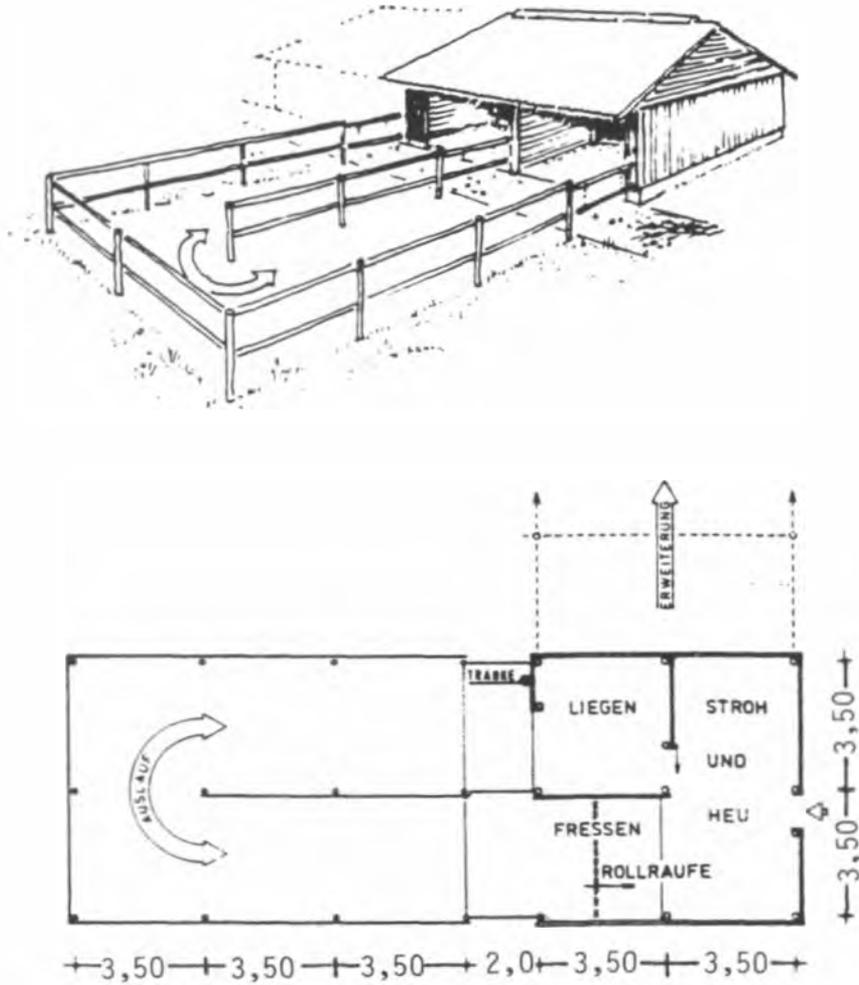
Mehrraum-Pferdeauslaufhaltung - Ansicht und Grundriß
